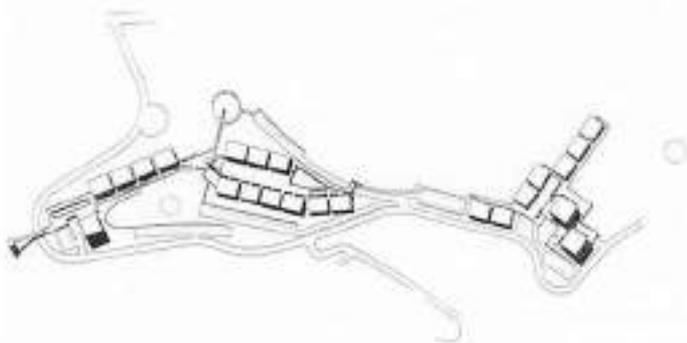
Riqualificazione area dismessa a Genova est: planimetria della zona di progetto dopo l'intervento.
